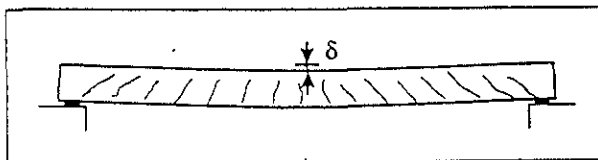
Deflexiones causadas por claros de gran longitud en concreto reforzado (flujo plástico) y cimbrado incorrecto
